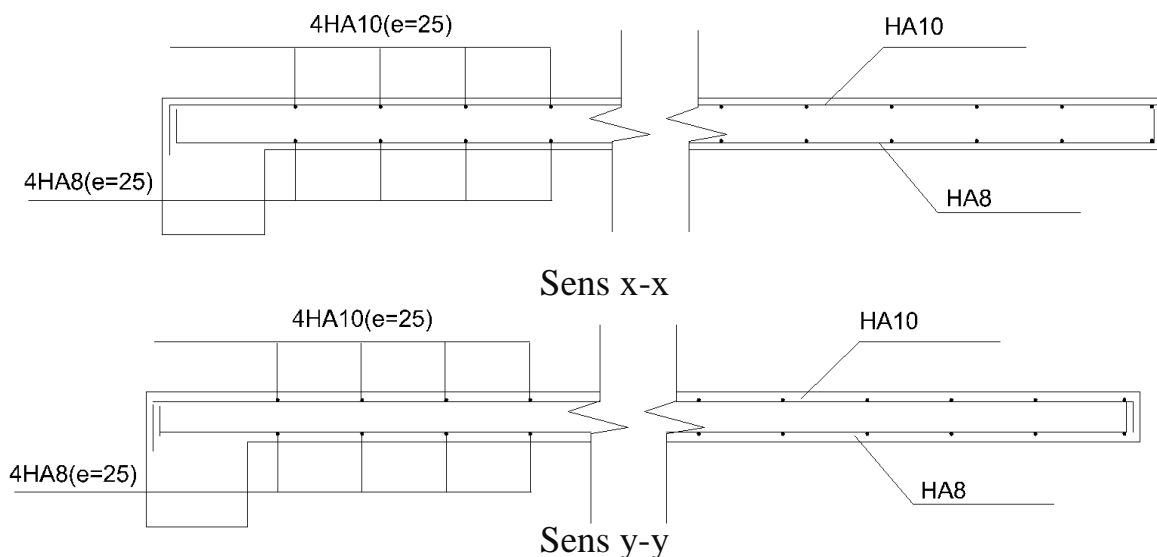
Ferrailage dalles sur 2 appuis adjacents
